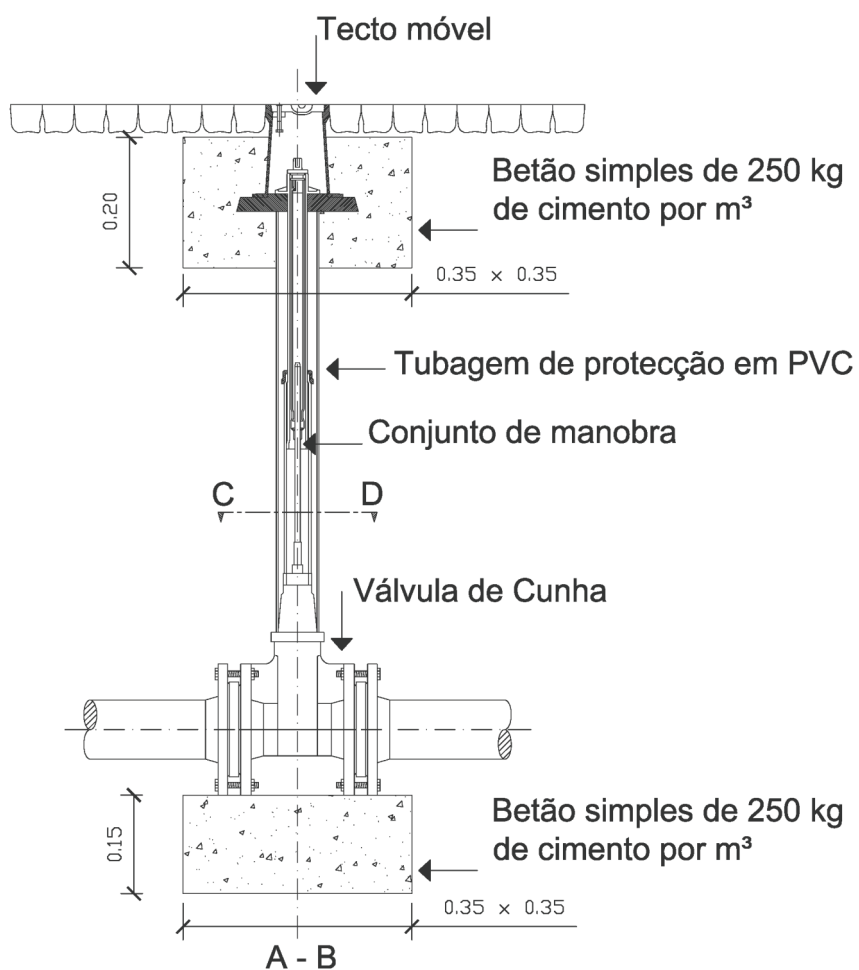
Perfil de implantação tipo de uma válvula de seccionamento
